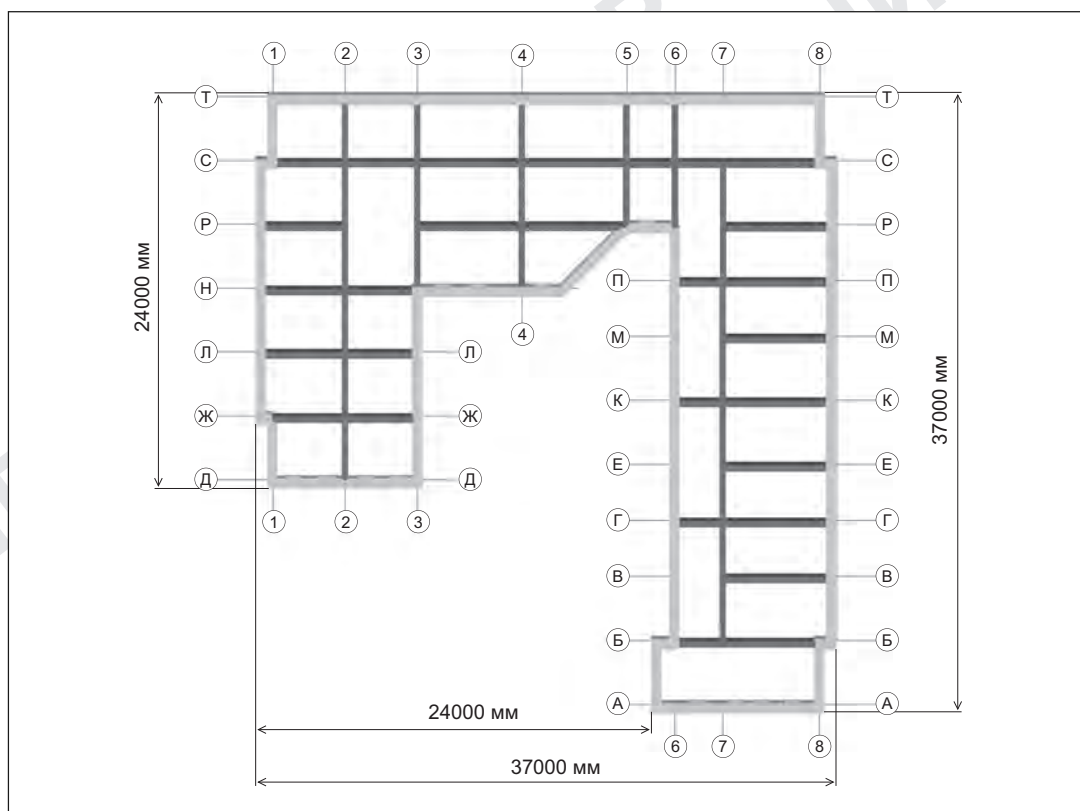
План типового этажа (внутренние несущие кирпичные стены толщиной 510 мм, внешние несущие кирпичные стены толщиной 640 мм)
